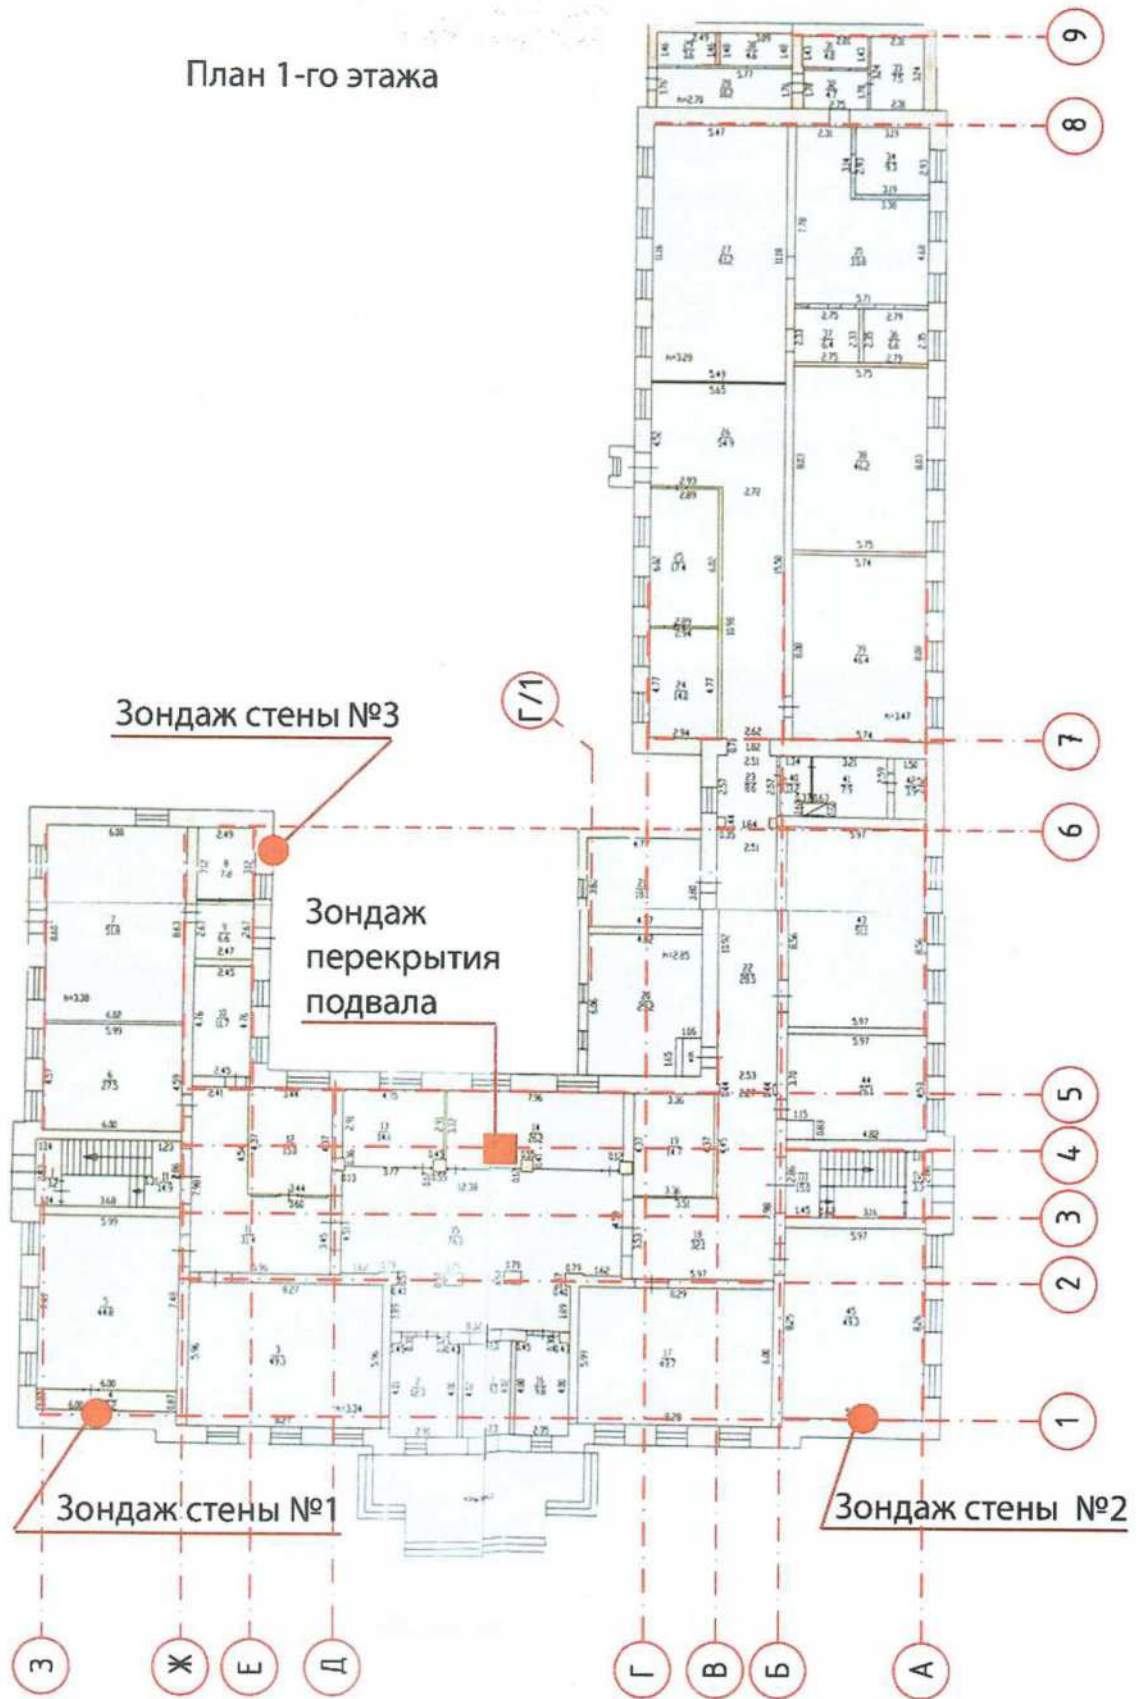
Местоположение зондажа перекрытия подвала и зондажей наружных стен на плане 1-го этажа.
